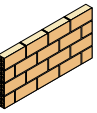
Aparejo a tizón. Muro de 1 pie de ladrillo perforado.
